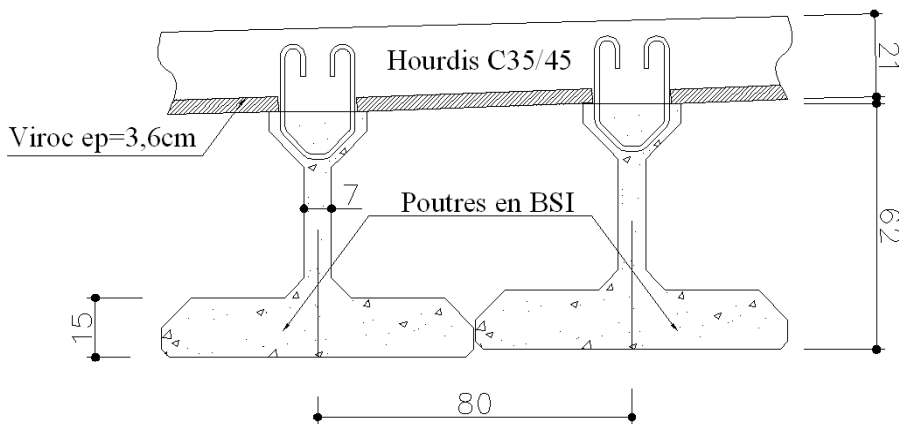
Pont Pinel – Coupe transversale de la variante avec poutres ITE®
